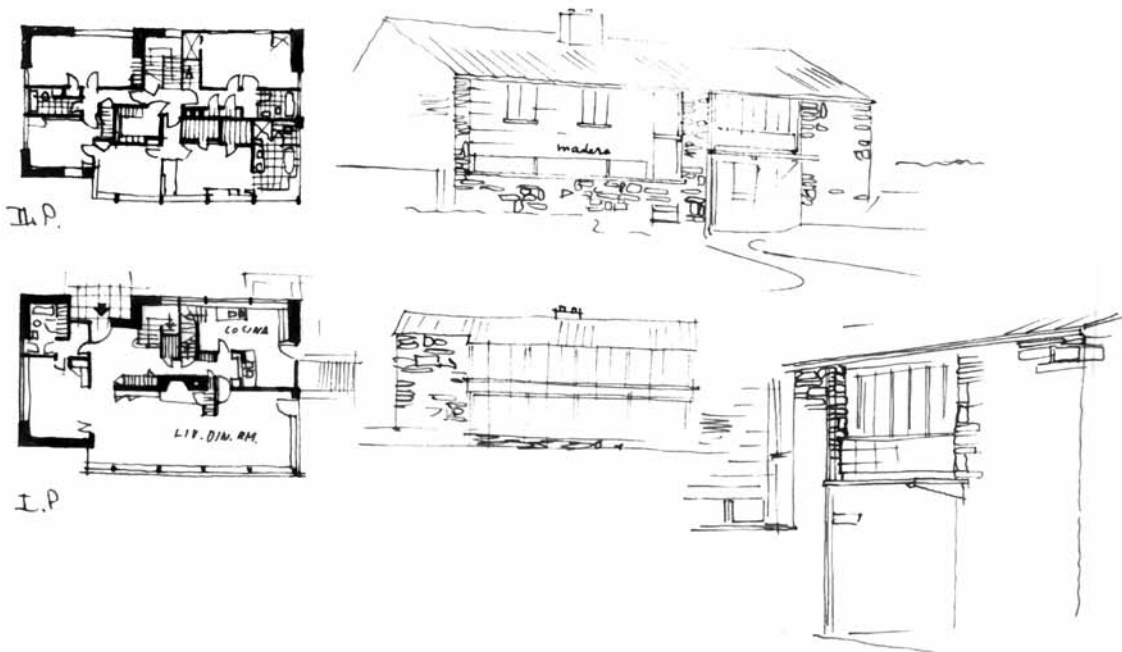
Proyecto Casa Campestre. “Plantas, vista, fachada y detalles”. Técnica: estilógrafo sobre pergamino
